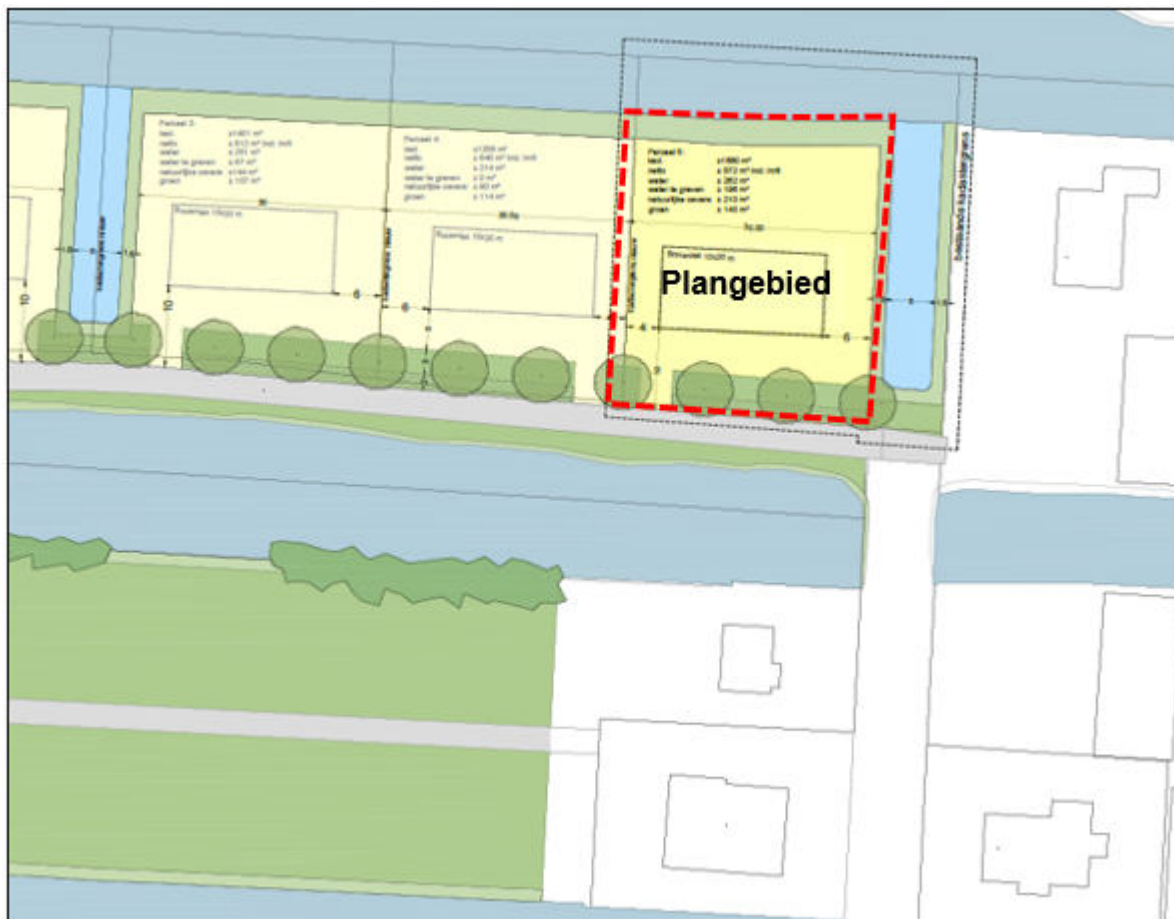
Verkavelingstekening plangebied tussen Elzenbroek 1-3 en 6 met vier woonpercelen.
